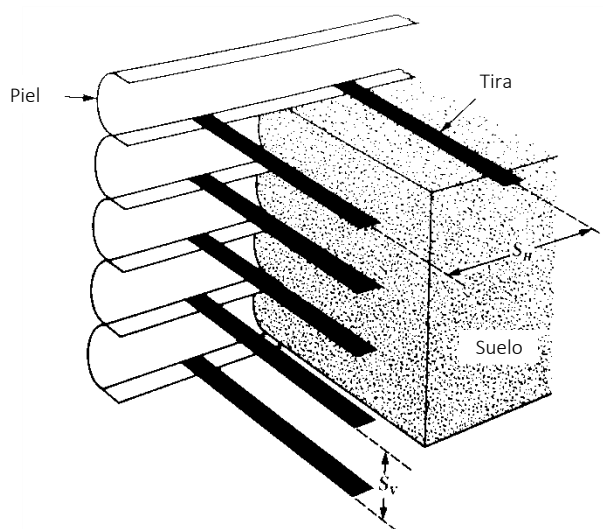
Constitución de un muro de tierra armada. Fuente: Das (2006)
